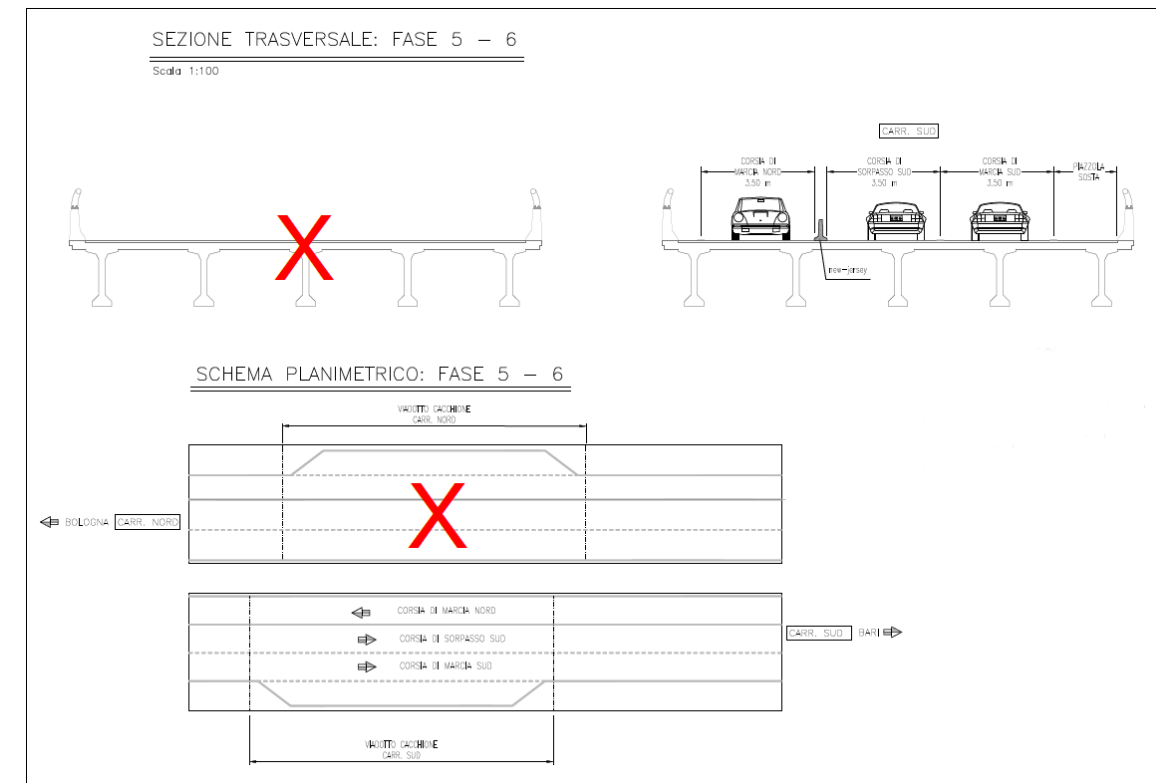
Sezione trasversale: Fasi 5 e 6
